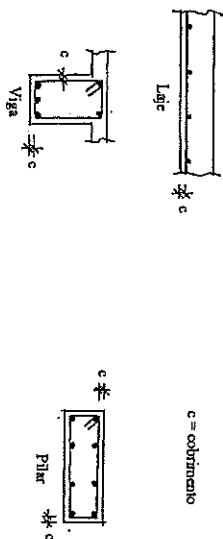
Cobrimento das armaduras em alguns elementos estruturais
